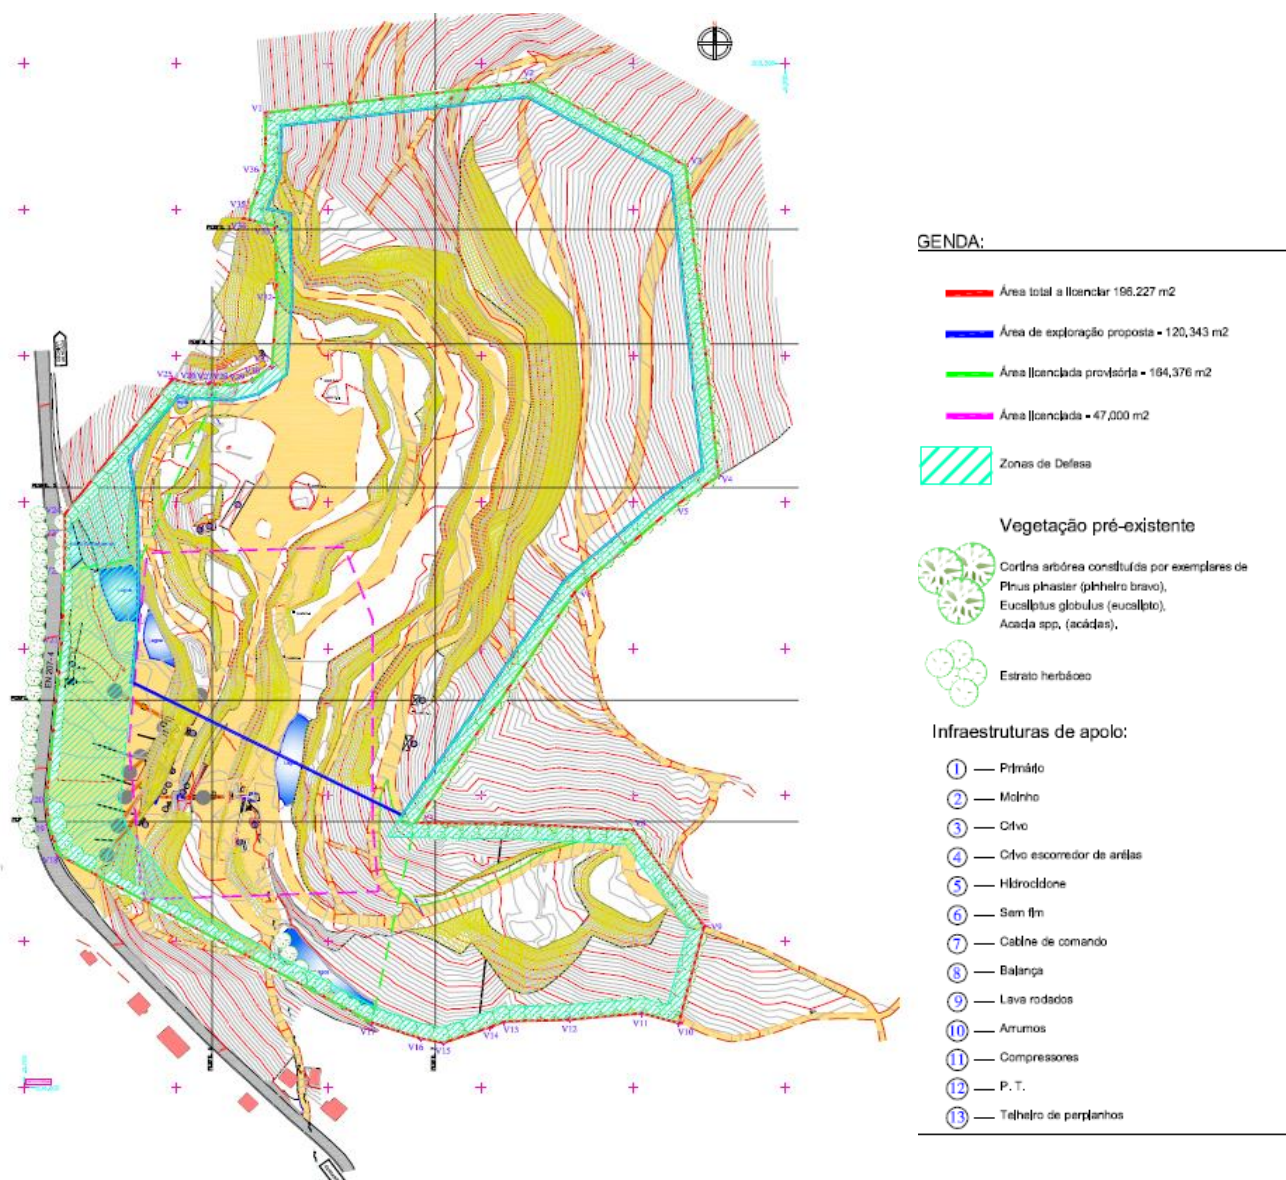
Planta da Situação Atual – Plano de Lavra (Escala 1:3.000)
